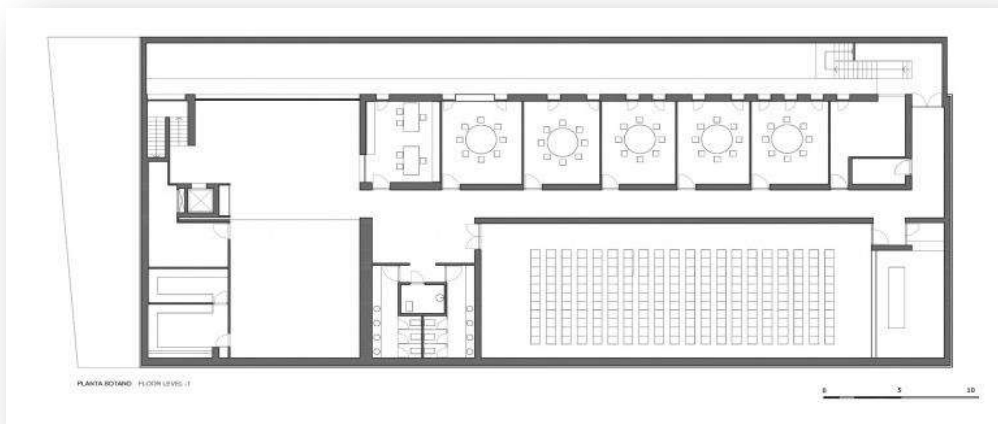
Planta arquitectónica del sótano de la iglesia de la parroquia de Córdoba.
